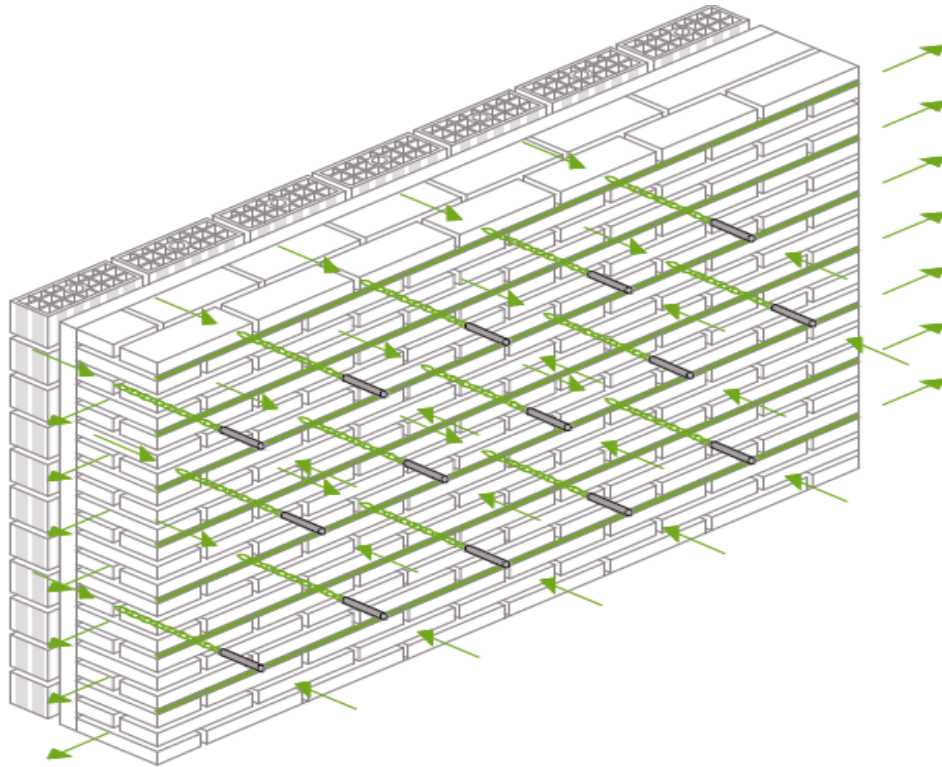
Inserción de barras de acero en un muro de ladrillos (Kerakoll, 2015)
